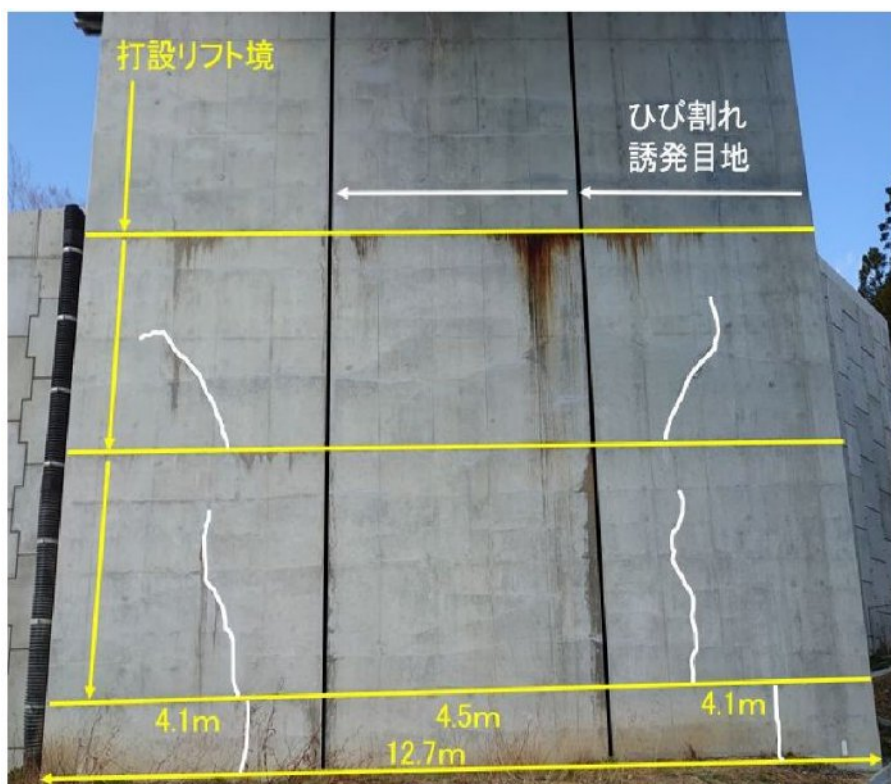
K 橋 A2 橋台ひび割れ発生状況
